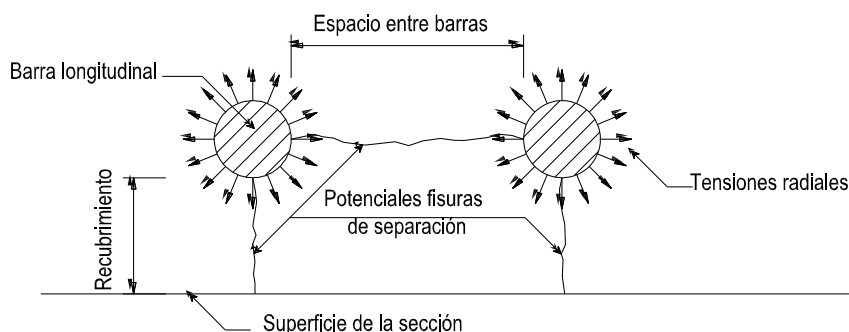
Fisuras y tensiones desarrolladas debido al anclaje de barras.
